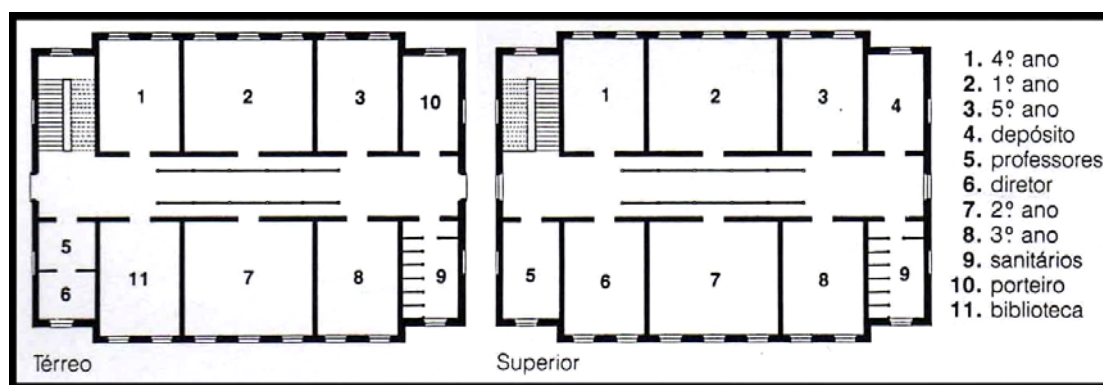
Planta dos G.E. de São João da Boa Vista e de Rio Claro.
